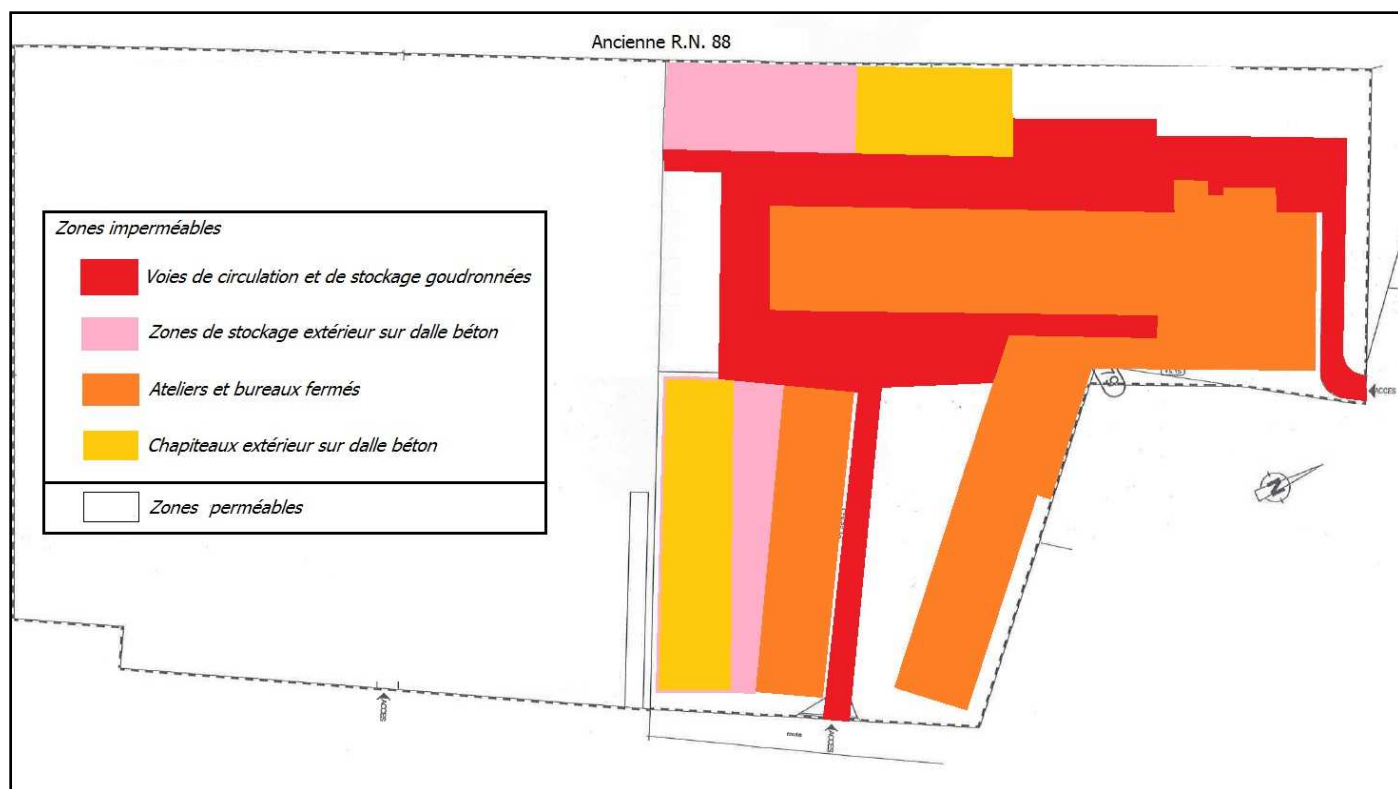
Plan des zones imperméabilisées – Situation actuelle
